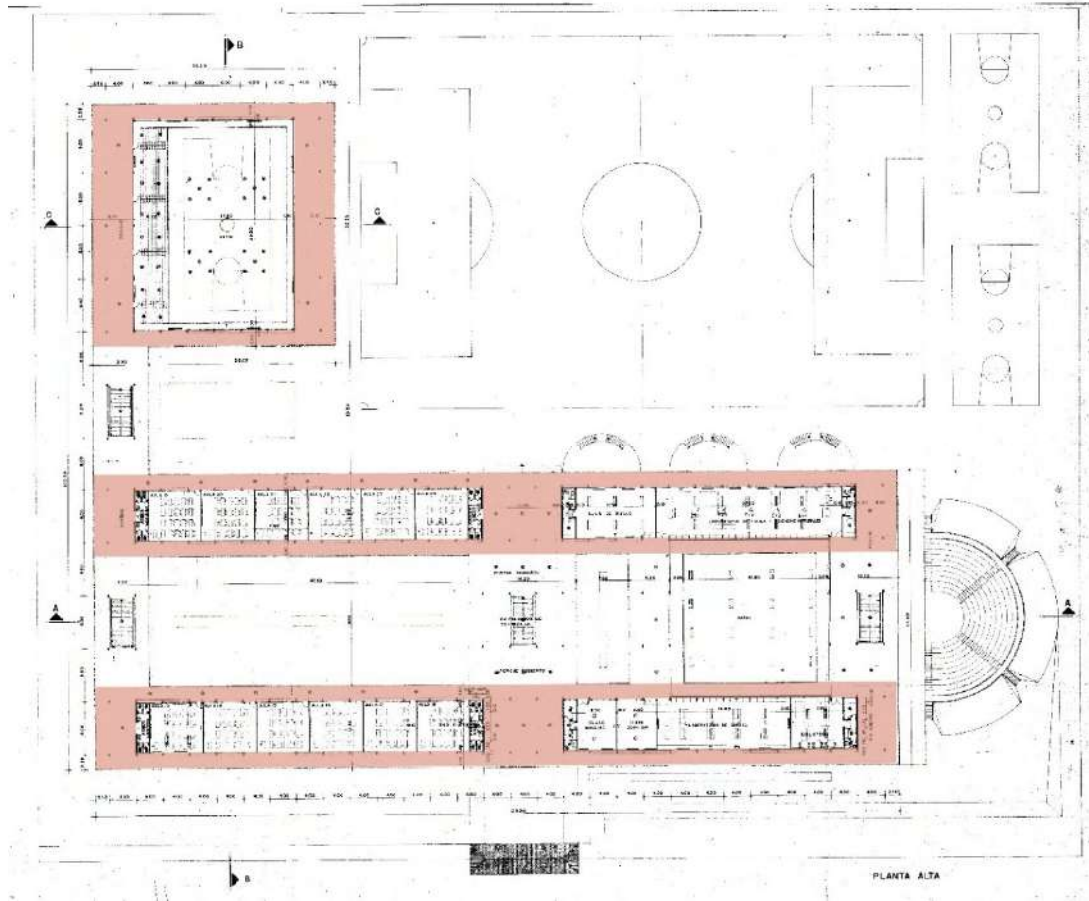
Espacios in-between en planta primera sobre la planimetría original del Colegio Aljarafe. Archivo Histórico del COAM.
